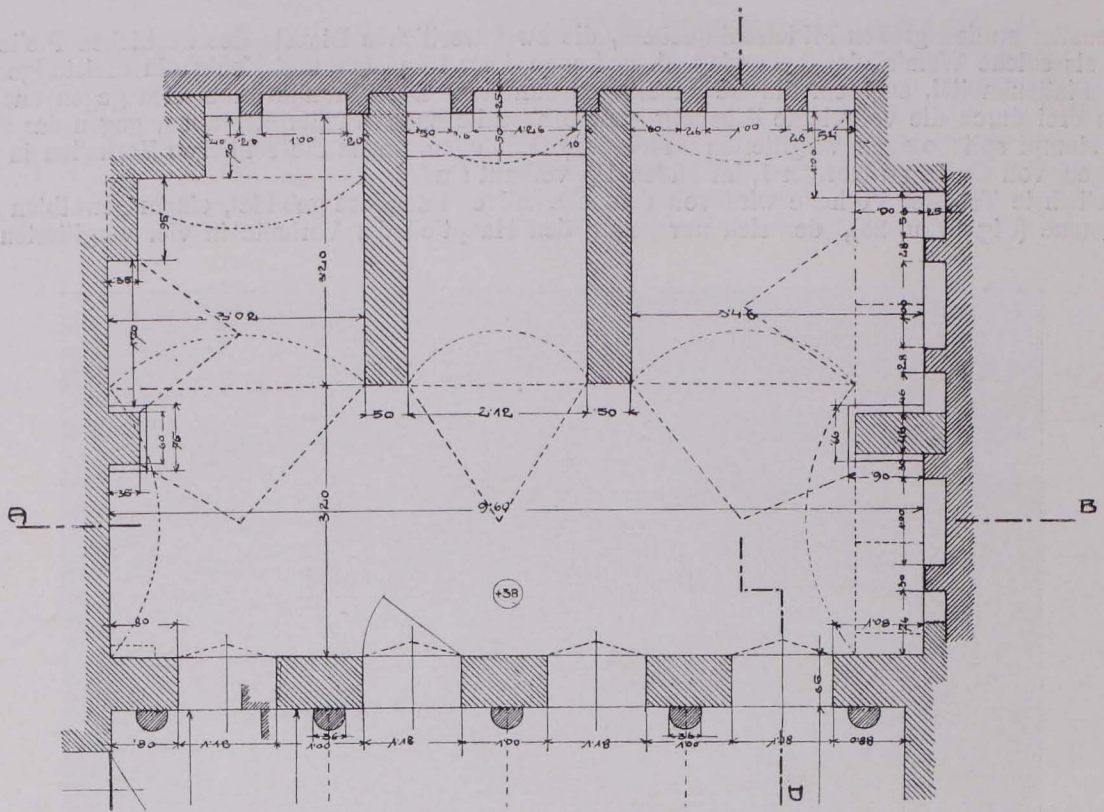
Vorhalle (Paradies), Grundriß (S. 17)
